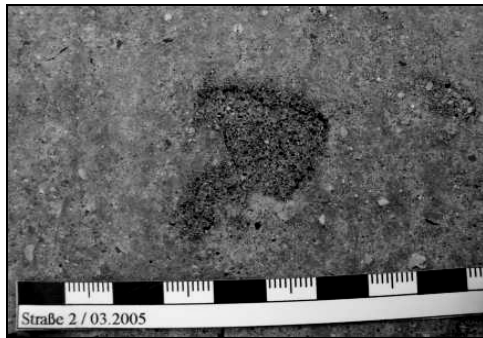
Straßenbeton 2: Oberflächliche Abplatzung im Alter von 10 Jahren
